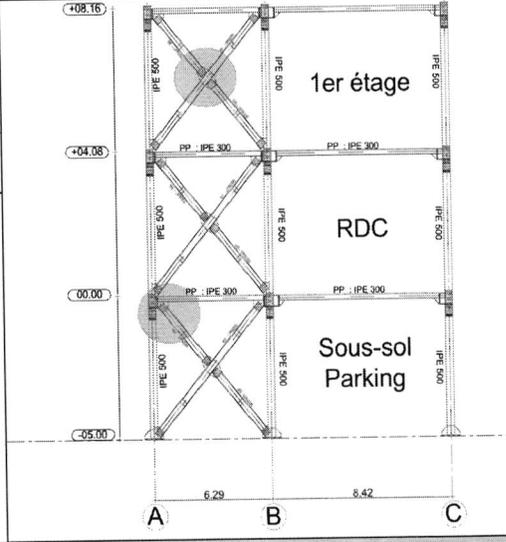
Coupe sur un contreventement vertical en forme de X. ECH 1/50
